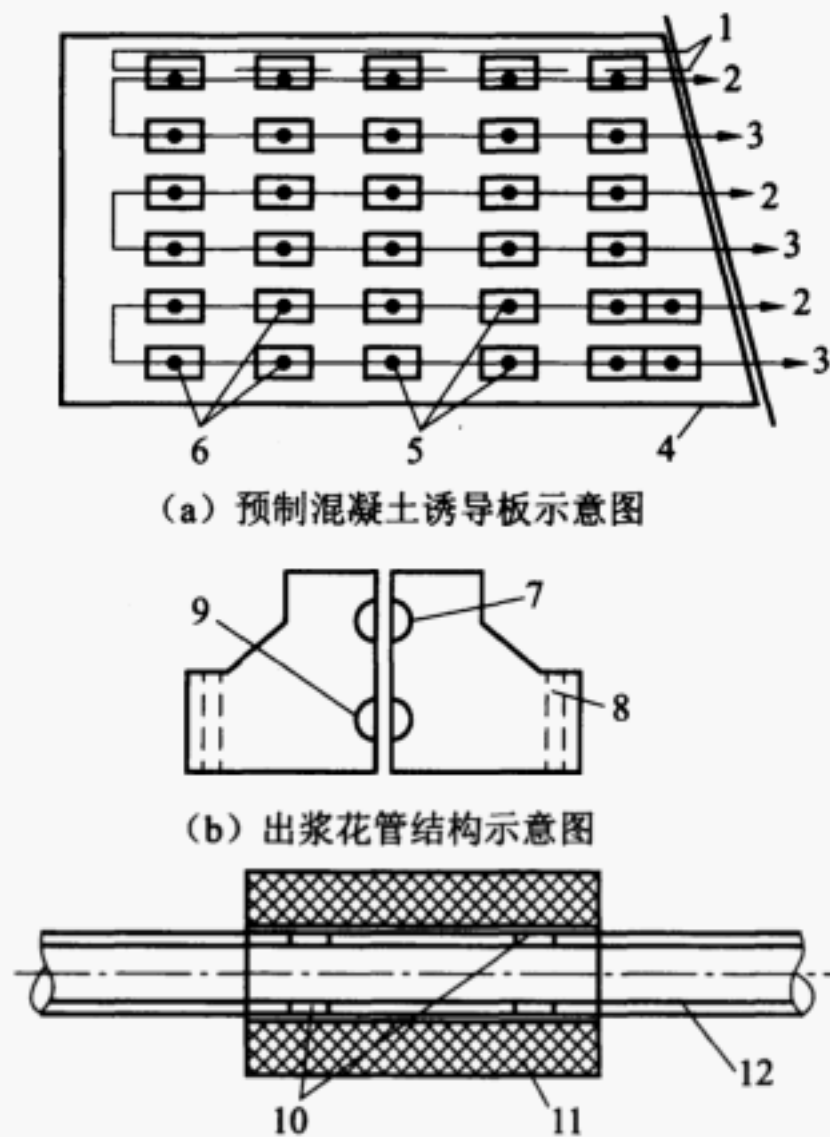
碾压混凝土坝重复接缝灌浆系统布置及
